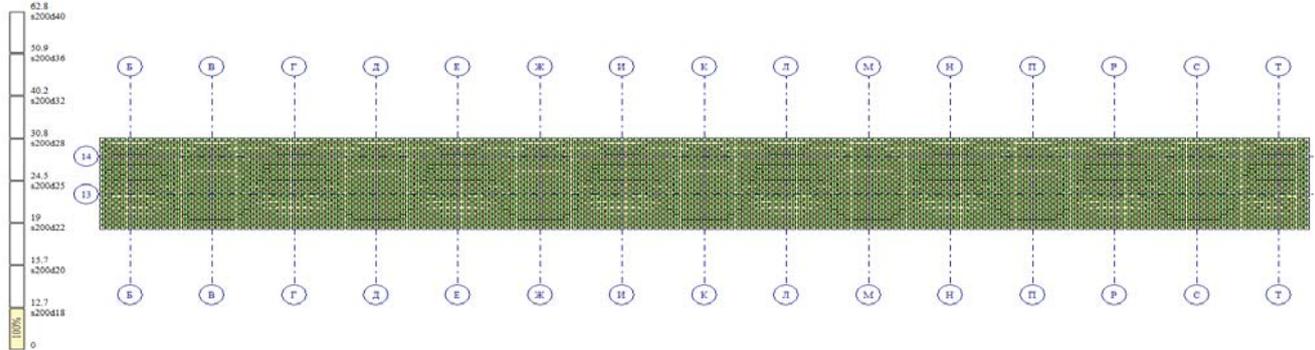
Верхнее армирование по двум направлениям в фундаментной ленте.
